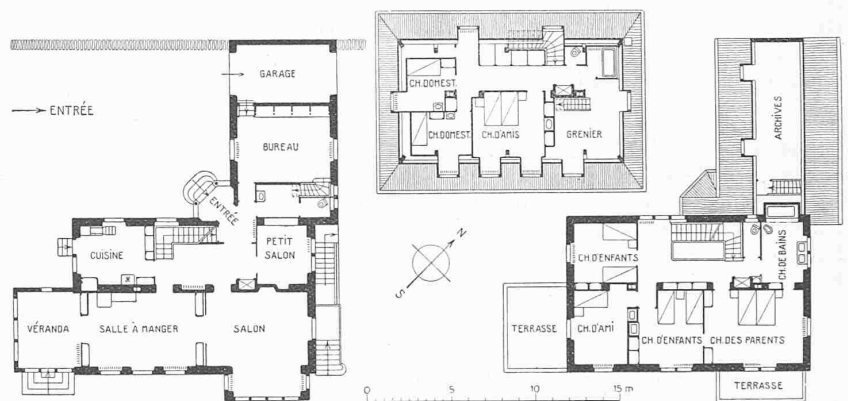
, 2 et 3. Plans de la Villa au Petit-Saconnex. — Echelle 1 : 400.
